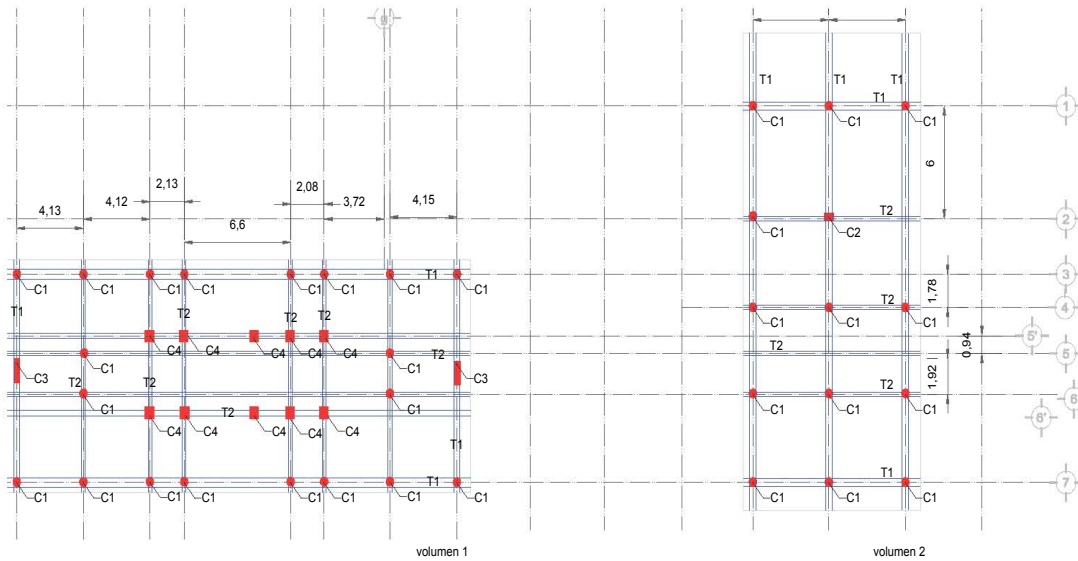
Planta estructural volumen 1 y 2. Fuente: creación propia
